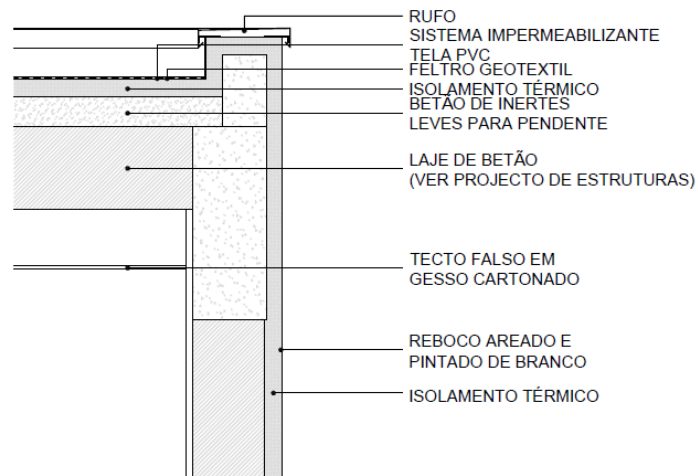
Pormenor construtivo da cobertura (arquitectura)
